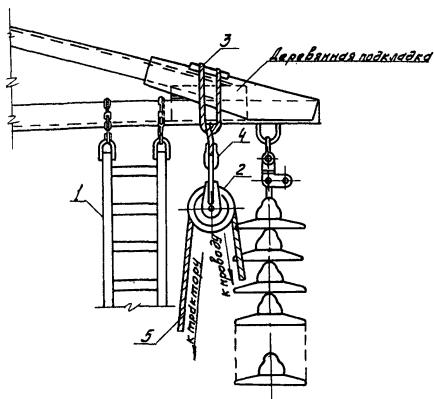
Узел „А“ Крепление монтажной лестницы и монтажного блока на траверсе при перекладке проводов
